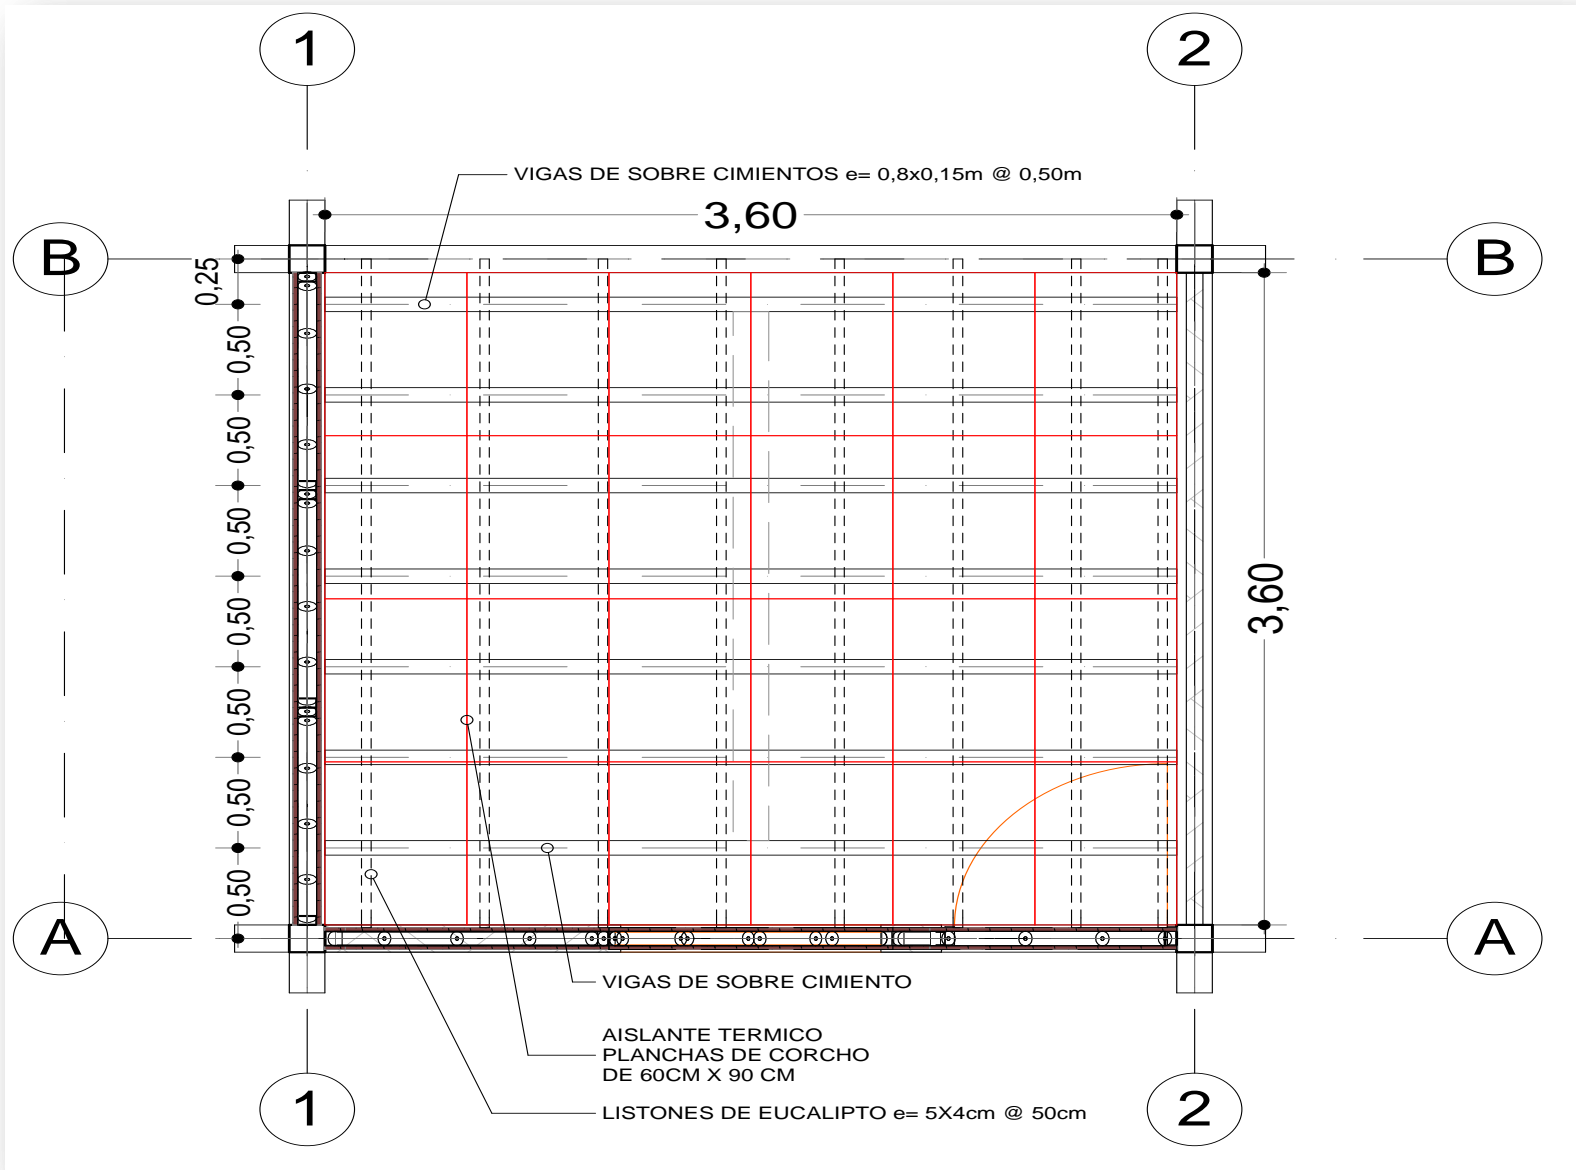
PLANTA DE ENVIGADO Y AISLANTE TERMICO
